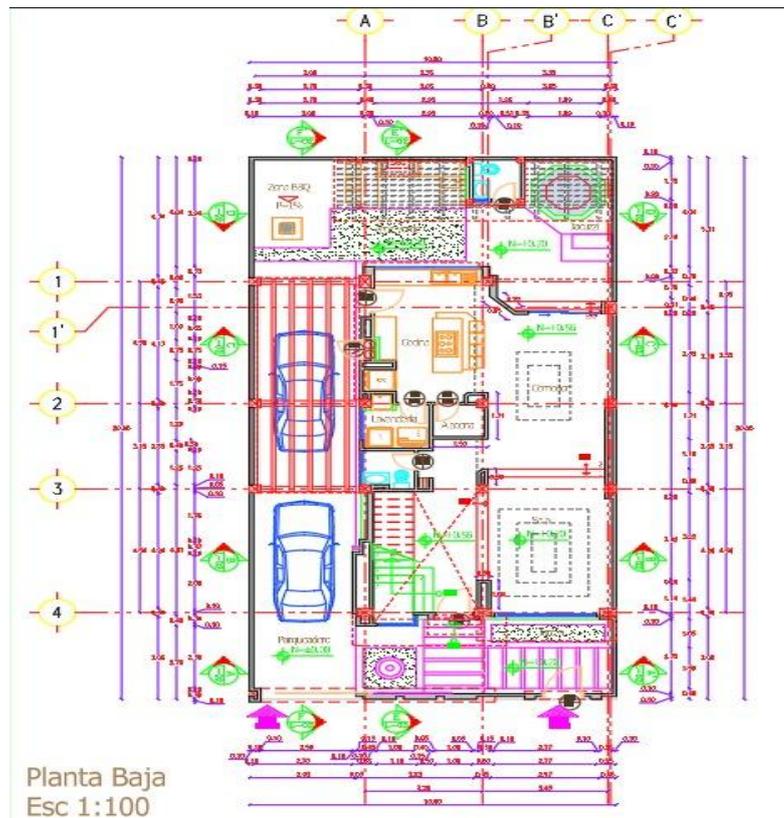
Planos metodología tradicional. Planta baja del proyecto Residencial "Aura Club"
